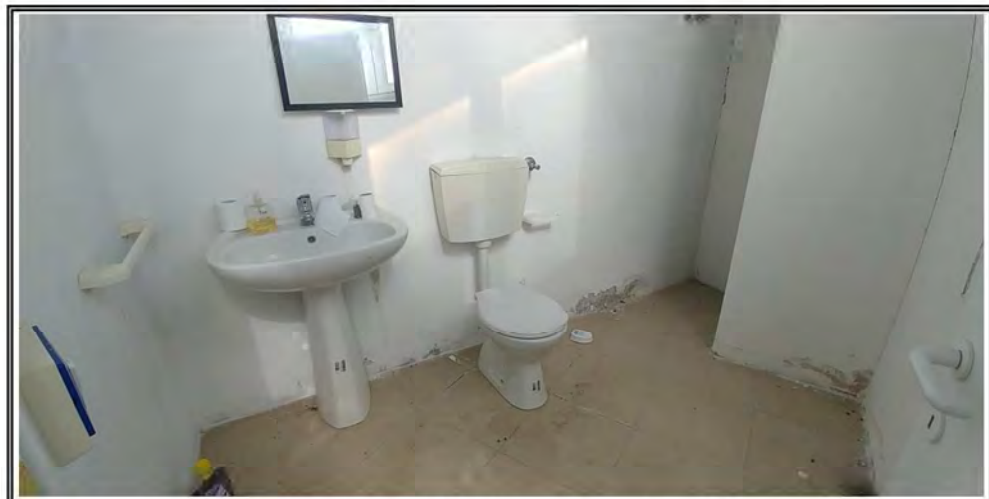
Subalterno 4 – Piano Terra – Servizio igienico
